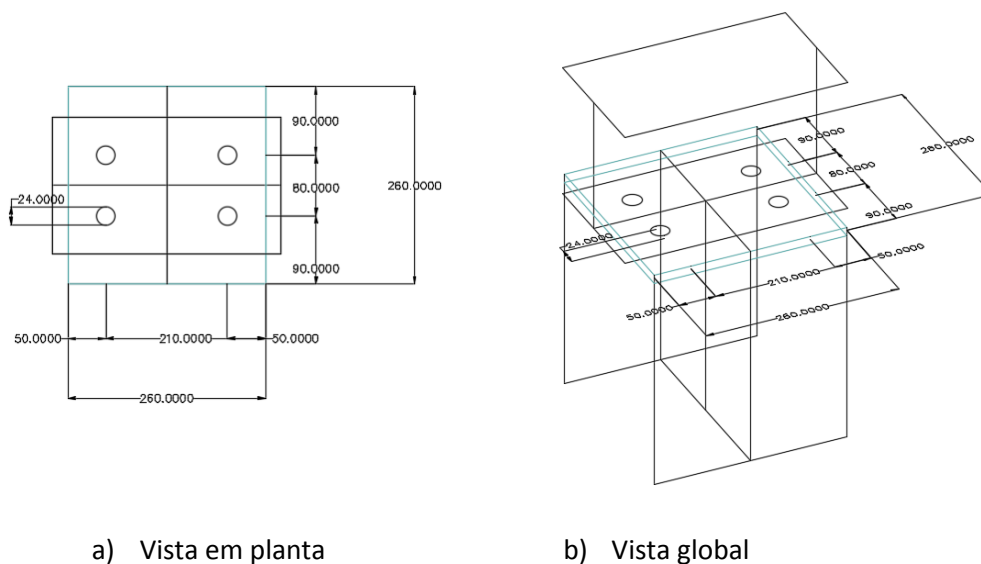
Pormenor construtivo da ligação dos pilares da fundação D às cordas inferiores da treliça
